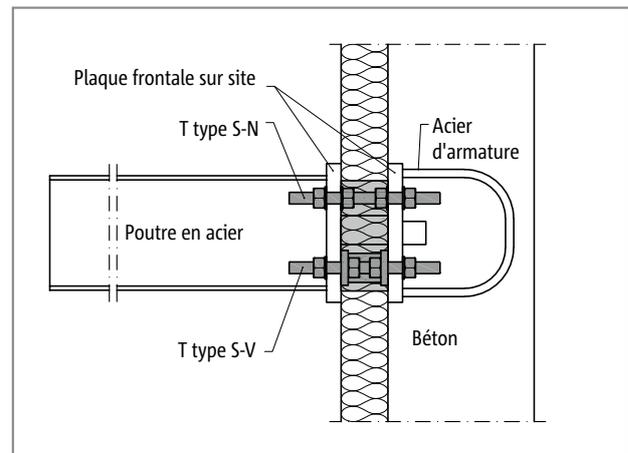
Schöck Isokorb® T type S-N et T type S-V : raccordement de structure en acier sur béton
